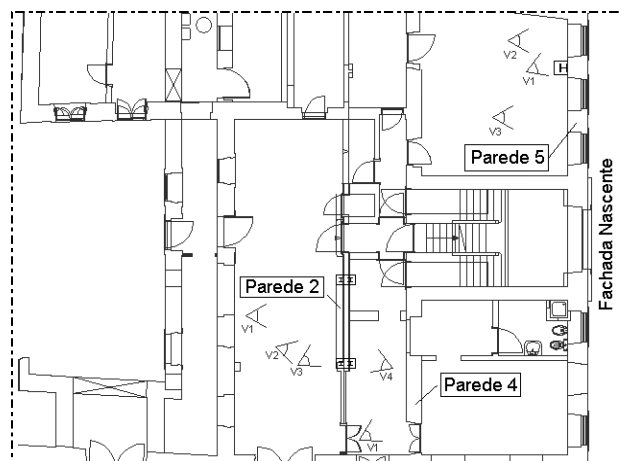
Planta parcial do piso -1 com indicação das paredes onde foi efectuado o ensaio de aderência
